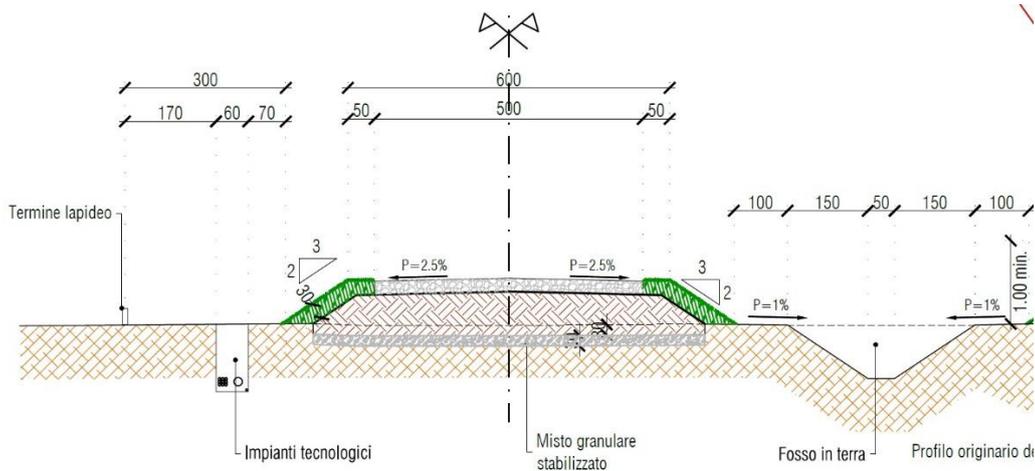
SEZIONE TIPO DELLE VIABILITÀ LOCALI DA DESTINARSI A PISTE DI CANTIERE DELL'AMBITO OPERATIVO N°1
